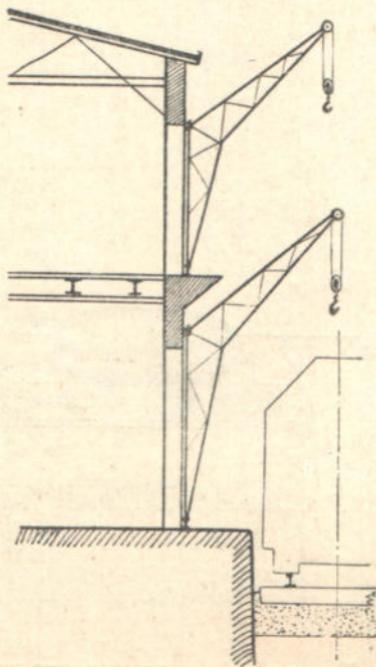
Схема оборудования портовых навесов и складов стенными кранами.
